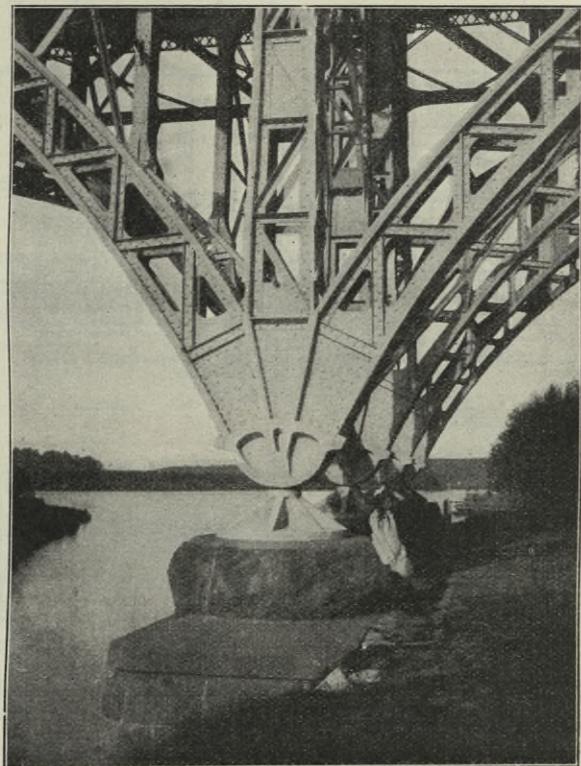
Auflager der Stößensee-Brücke bei Berlin.
